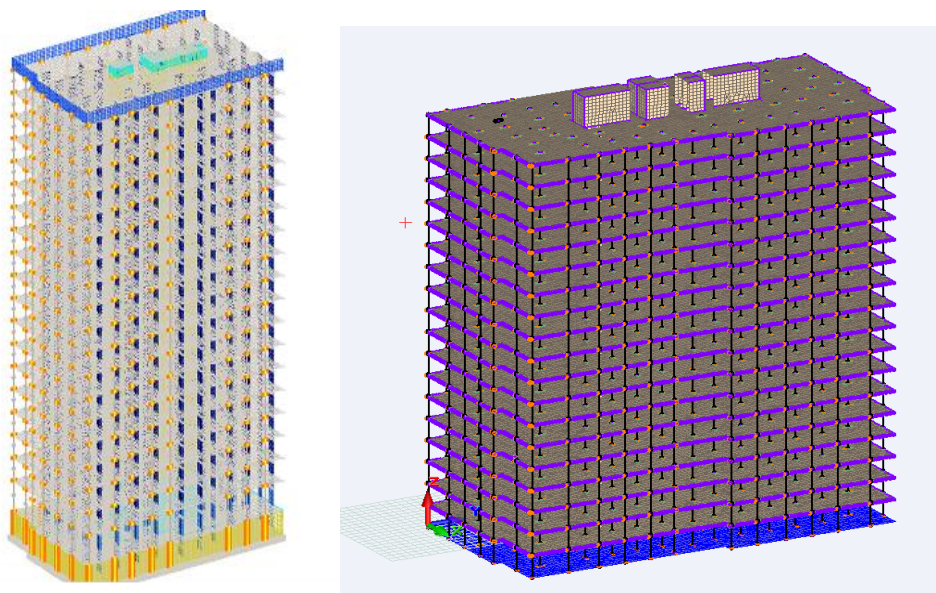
Схема будівлі в 3D 1. без балочна плита; 2. балочна плита
